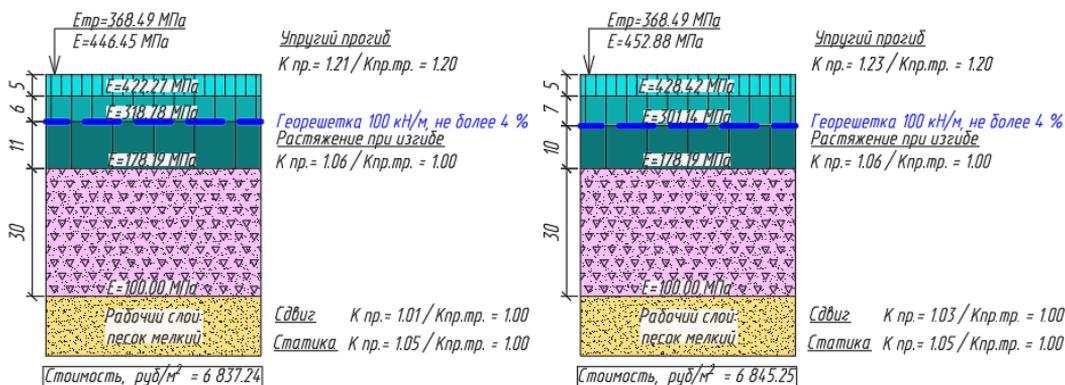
Результаты расчета конструкции дорожной одежды с армированием асфальтобетонного покрытия
